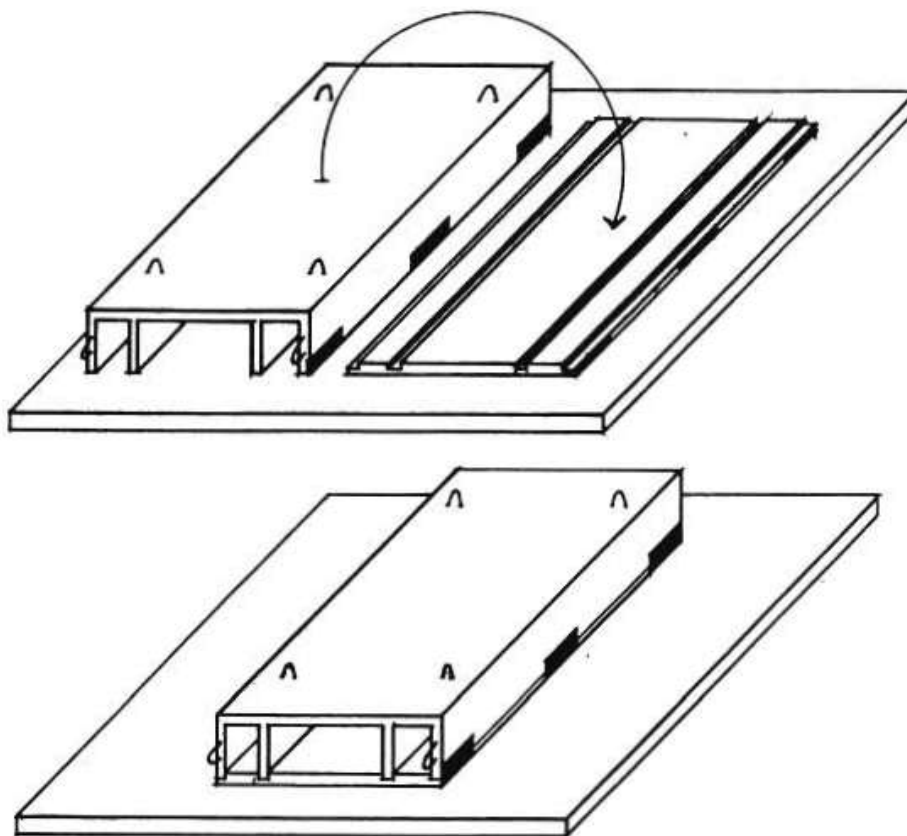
Схема монтажа элементов вентиляционного блока
